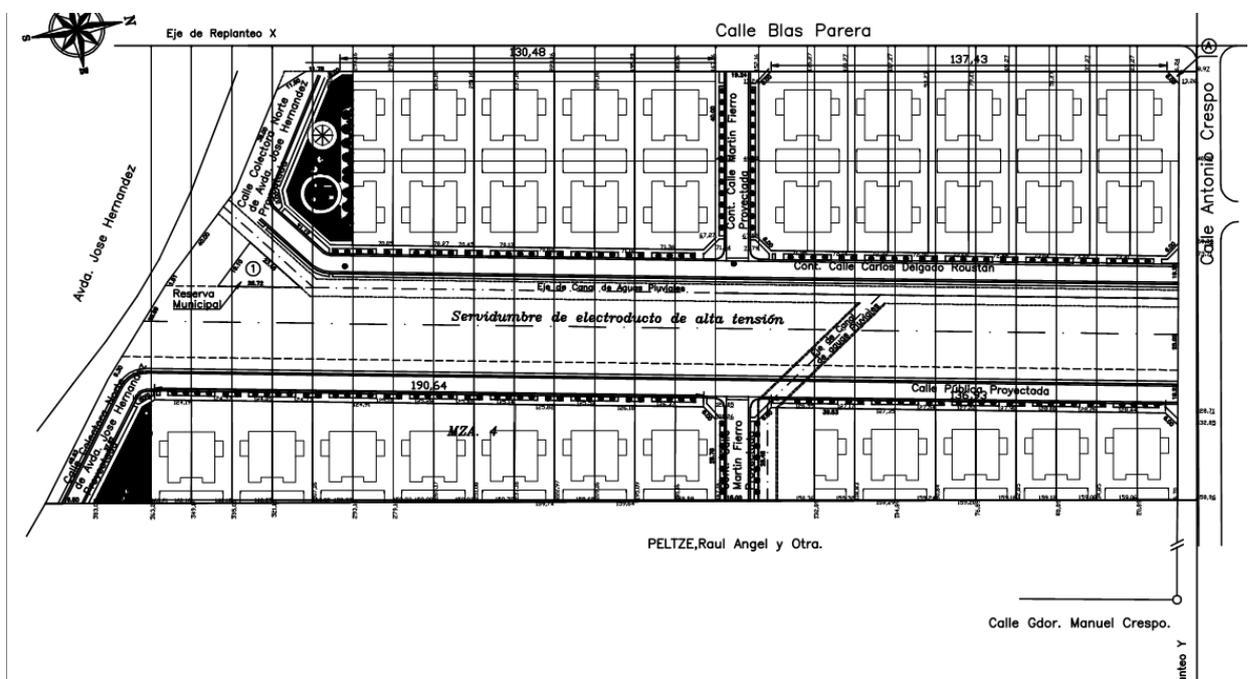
Plano de Urbanización y Replanteo del Conjunto, propuesto en el TP
